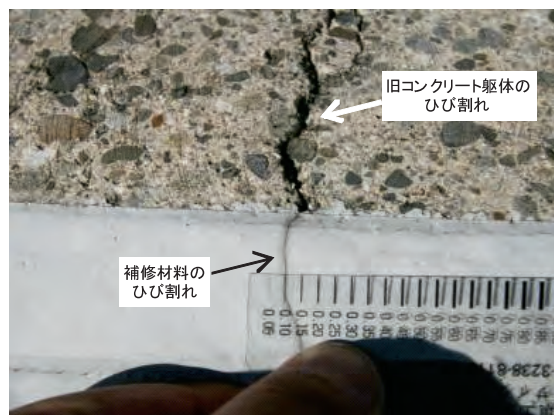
に現場打ちコンクリート製開水路表面に施工された断面修復材の一種であるポリマーセメントモルタル（以降PCMと示す）に鉛直方向に発生したひび割れの状況を示す。この水路は目地間隔が10mあり、旧コンクリート躯体に既に温度の影響あるいは施工後初期の乾燥収縮によると思われる鉛直方向のひび割れが存在し
